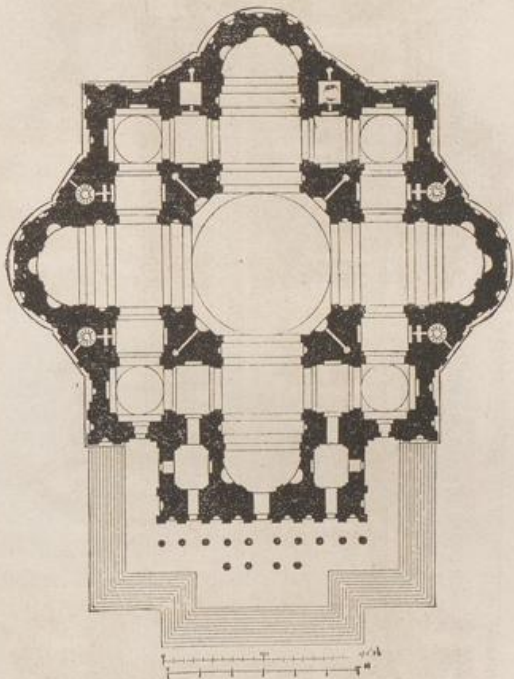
Michelangelo's Grundriss für St. Peter.
